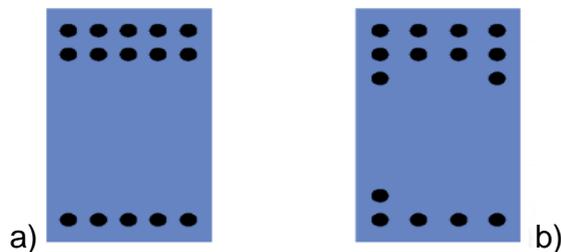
(a, b): (a) arreglo del acero en la sección transversal de una viga según diseño, (b) modificación de la distribución del acero en viga, practicada en obra.
